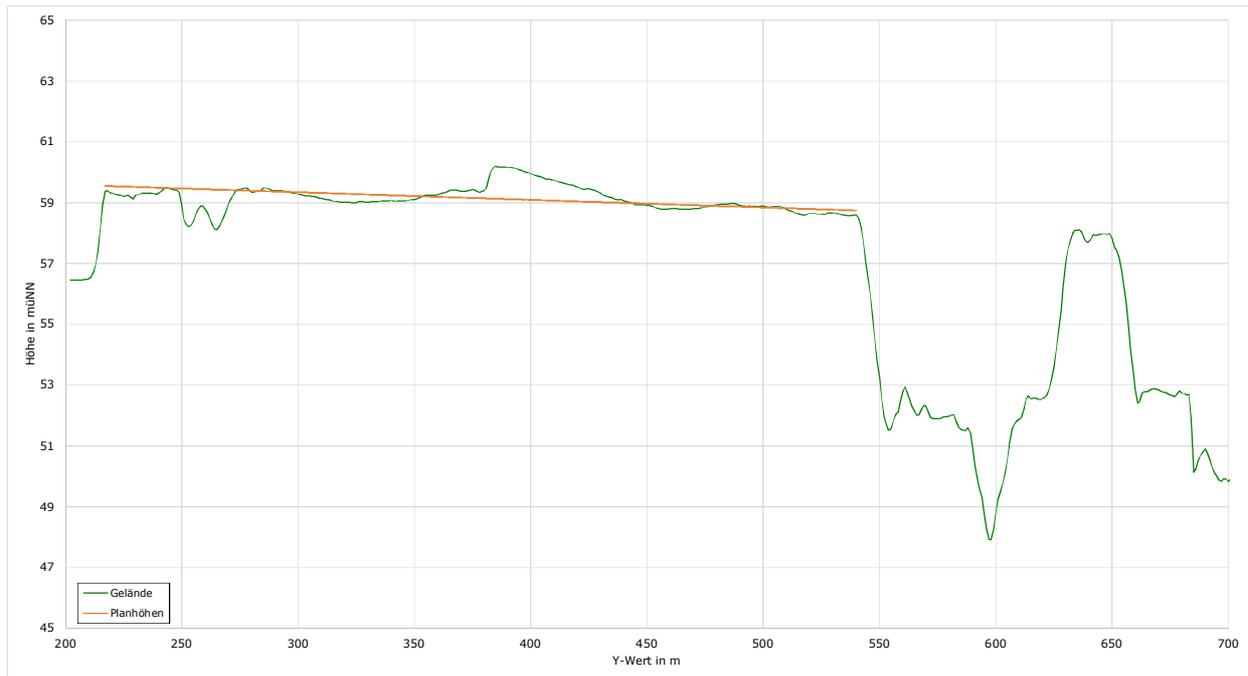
Süd-Nord-Schnitt durch das östliche Planungsareal einschließlich Neuem Mühlenbach (tiefer Einschnitt) und Bahndamm (hohe schmale Dammlage); in orange ein massenneutrales Planum mit 0,25 % Gefälle nach Norden
